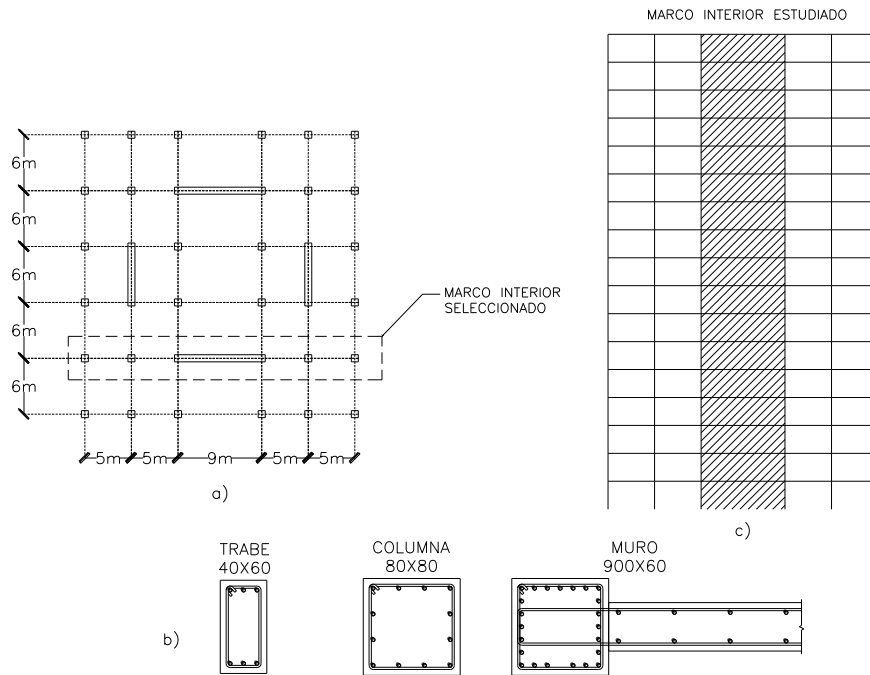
a) Vista en planta; b) secciones transversales; c) elevación del marco en estudio (adaptada de Vaduva et al., 2012)
